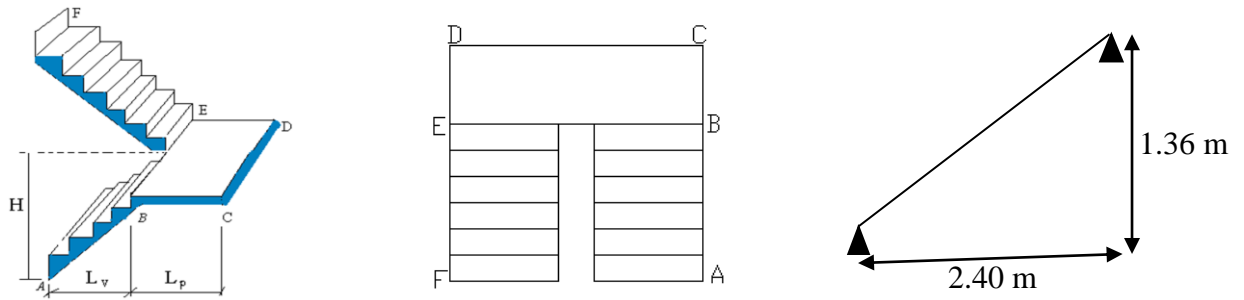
Vue en 3D , en plan et statique de l’escalier type 2
